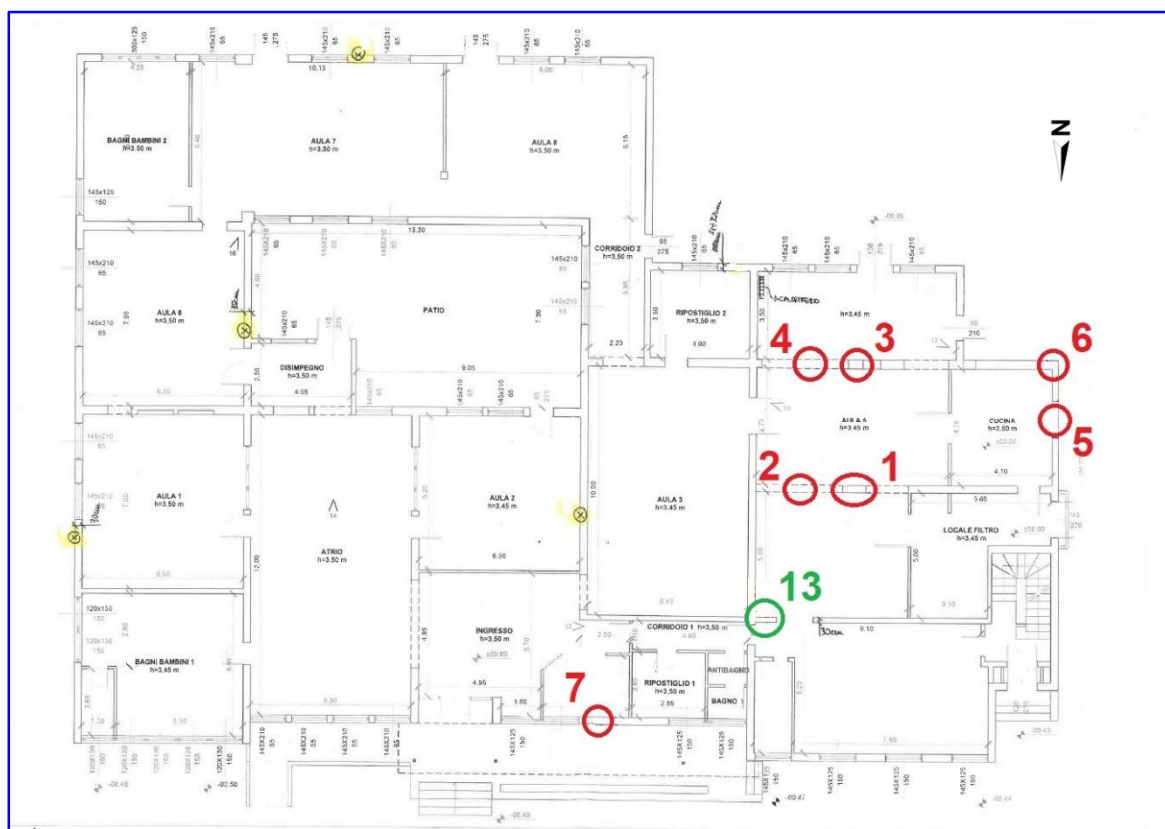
Planimetria piano terra con ubicazione delle 8 zone esaminate
